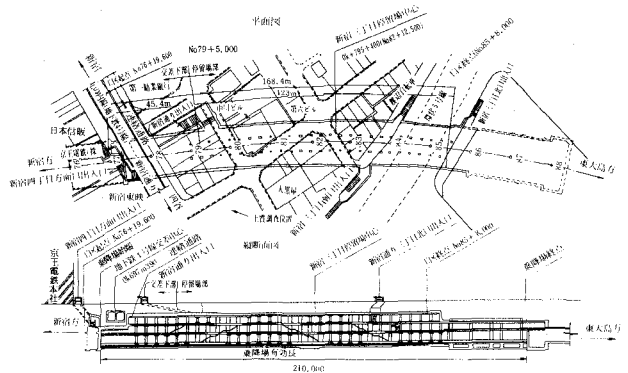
都営地下鉄新宿線新宿三丁目駅部平面縦断面図
